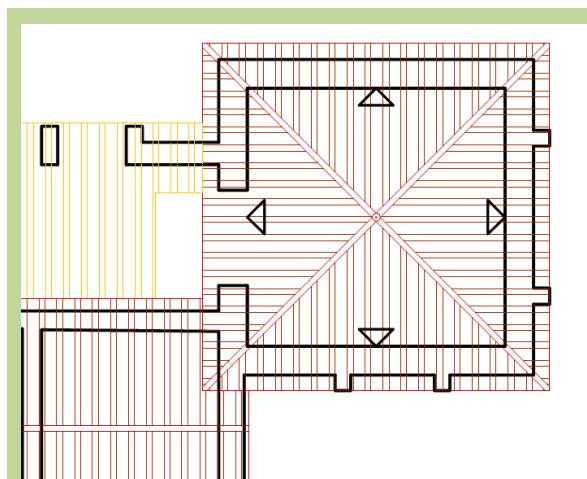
Planta de la torre cuadrada oriental (reconstrucción virtual). CGS.
